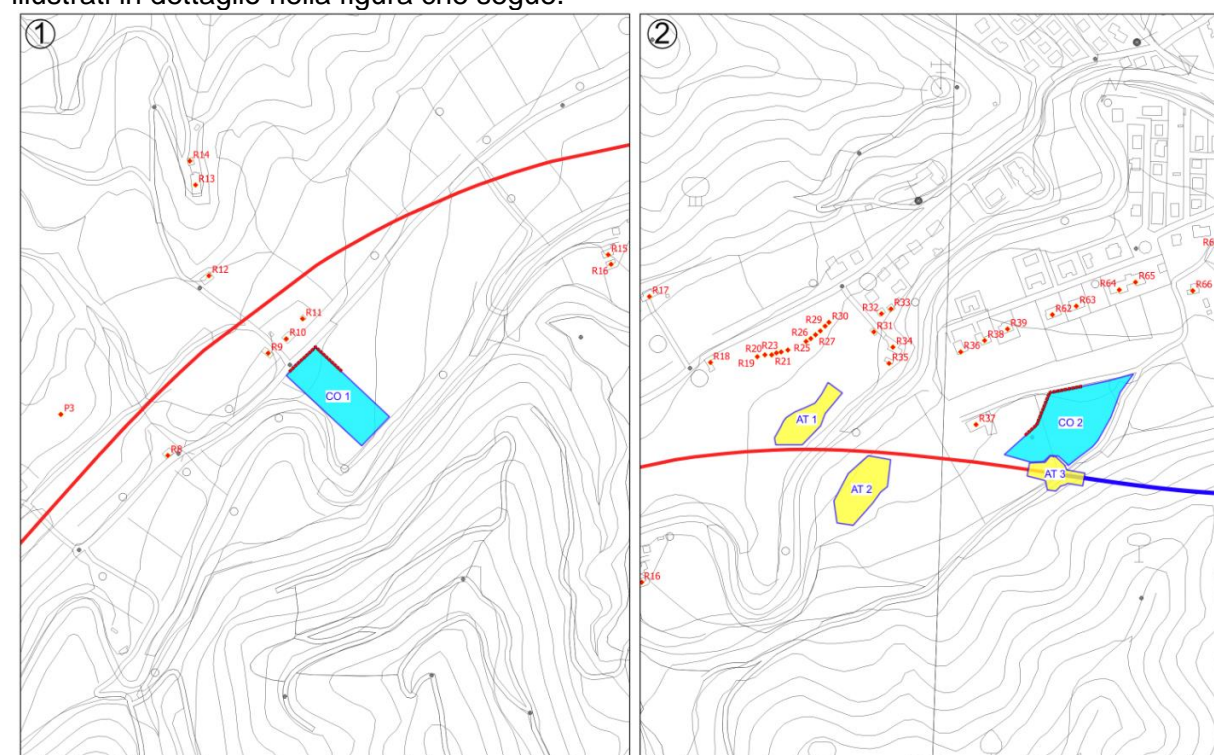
Cantieri CO1 e CO2 con barriere (linea rossa con tratteggio).
